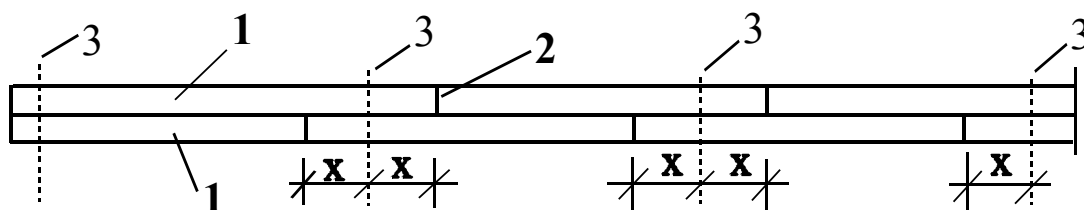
Схема спаренного неразрезного прогона (вид сверху)
